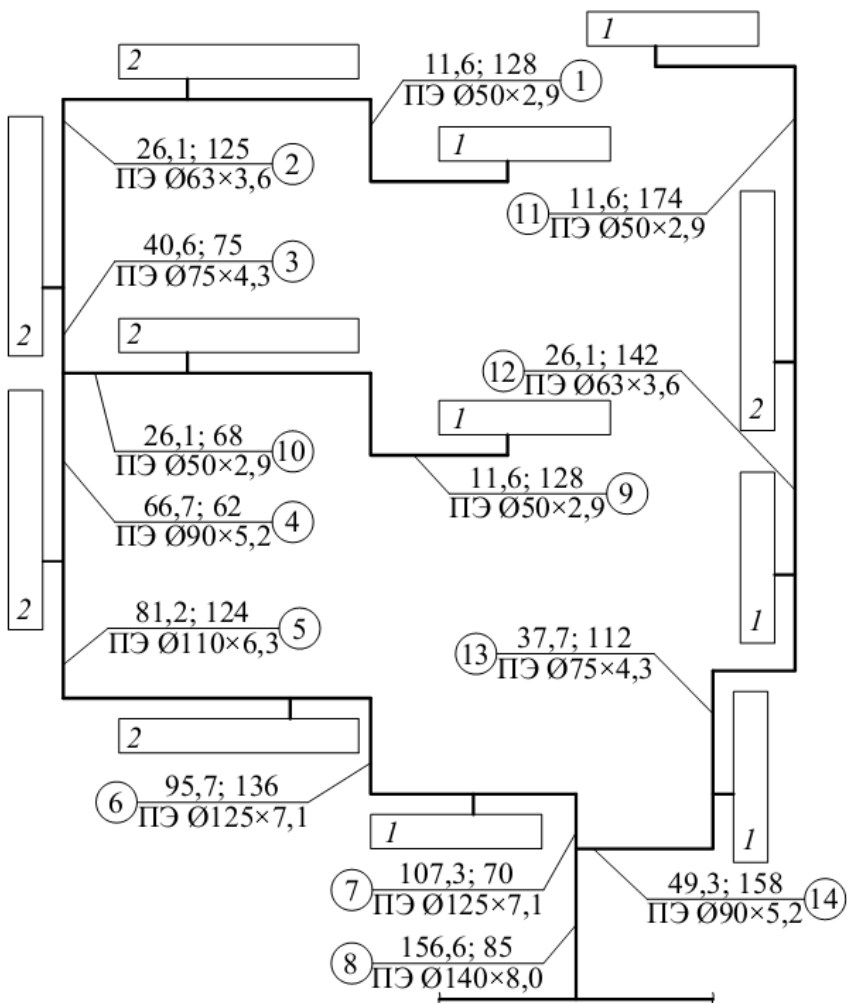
Расчетная схема квартальных газопроводов низкого давления
